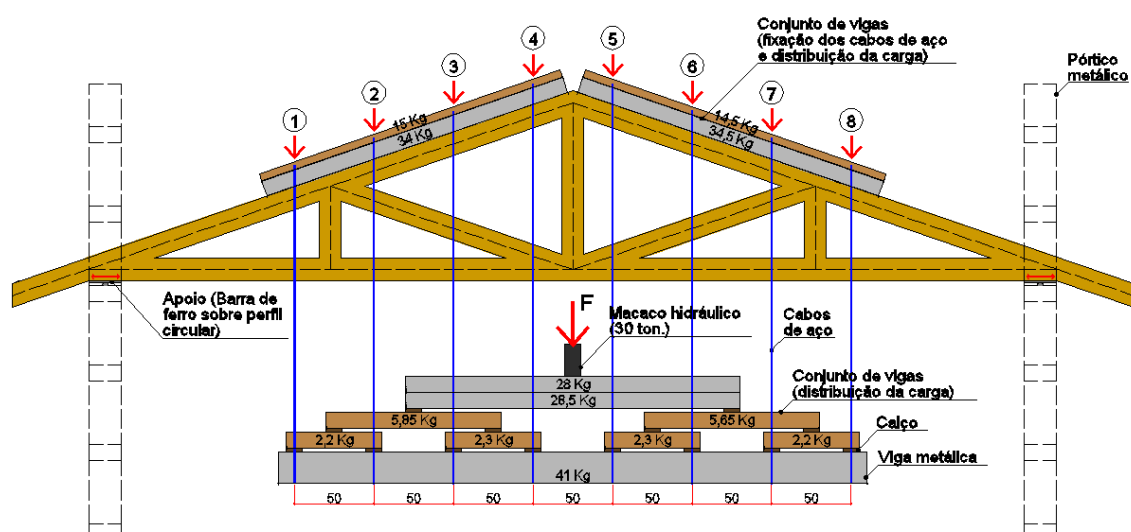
Indicação dos 8 pontos de aplicação da carga, dos pesos do conjunto de vigas e modo de aplicação da carga para o ensaio de ruptura do Sistema Caibro treliçado em MLP.
